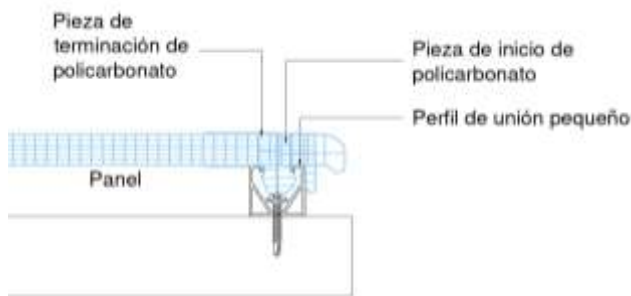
Detalle del encastre del último panel con perfil de unión.
